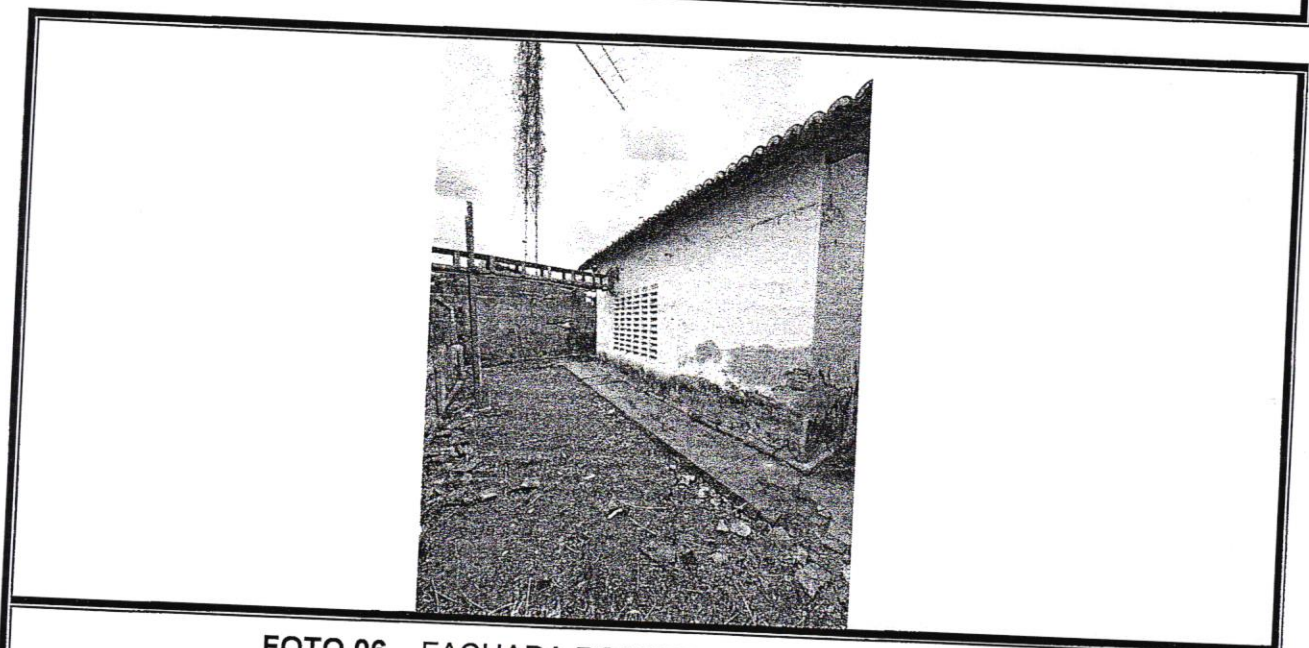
FACHADA POSTERIOR DA EDIFICAÇÃO
